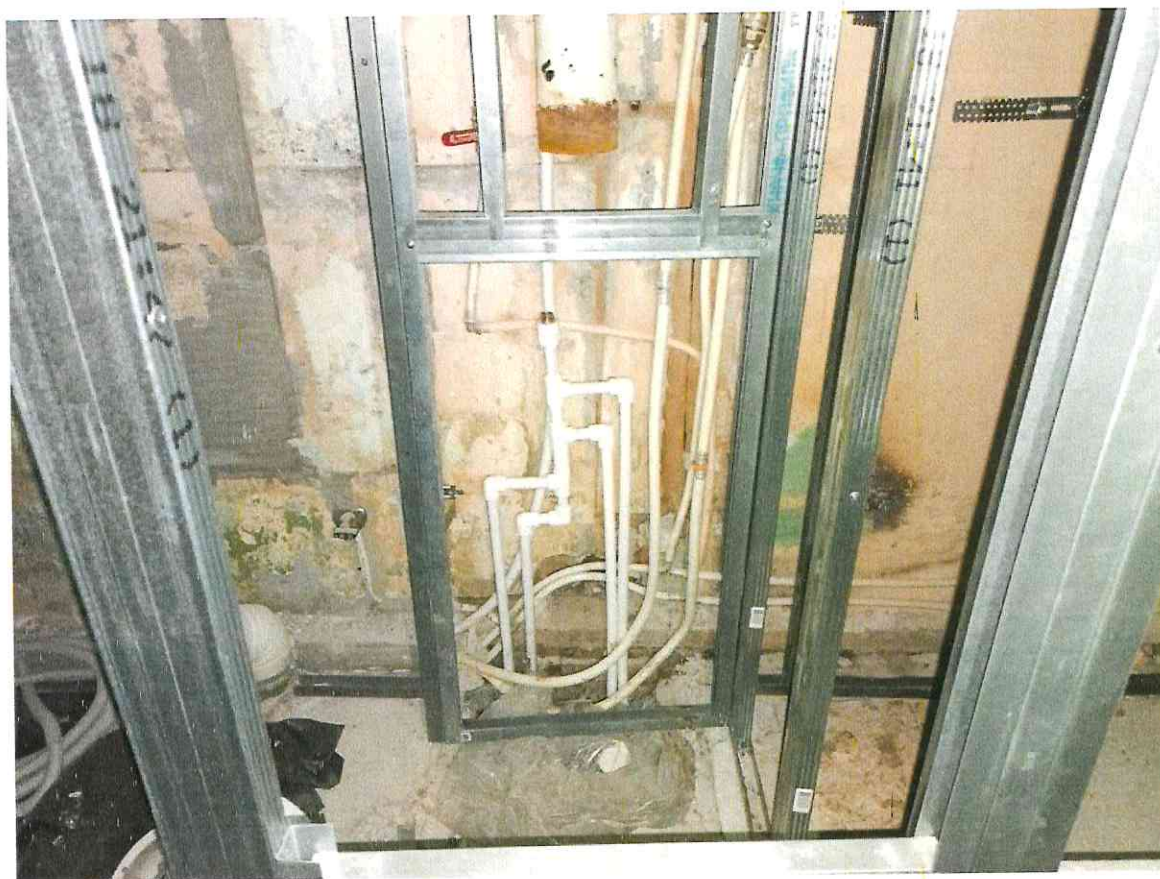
Состояние трубопроводов системы водоснабжения и водоотведения
